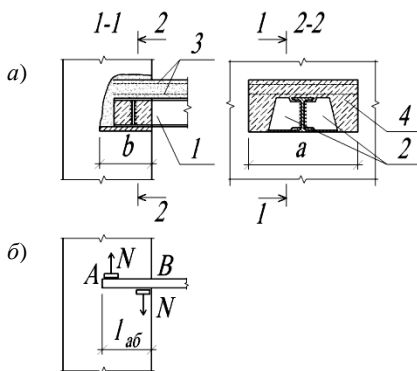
Конструктивное решение (а) и расчётная схема (б) жёсткого узла стальной балки в кирпичной стене:
